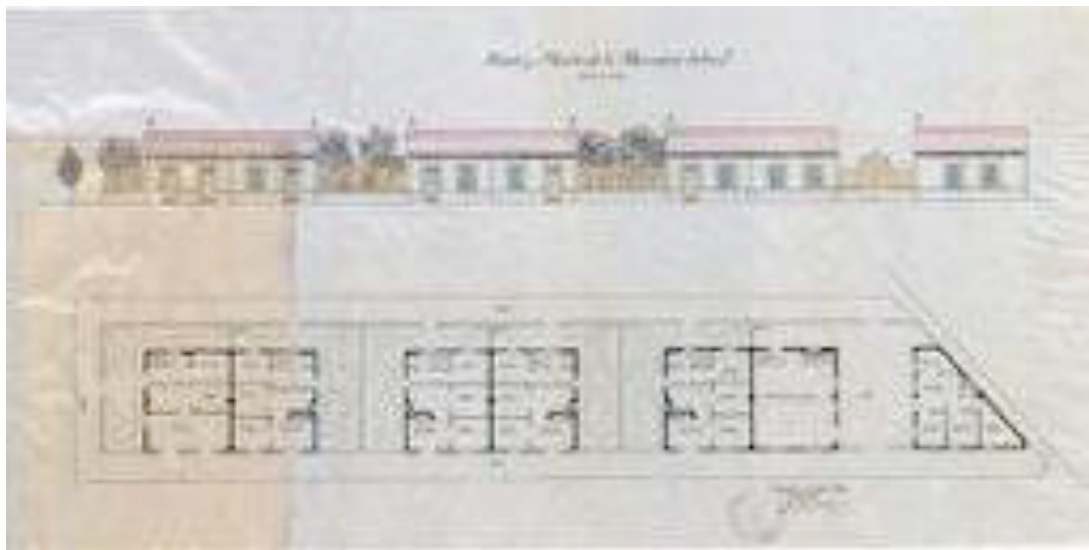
"Alzado y planta de la Manzana letra I". Francisco P. Oliver. 10 de julio de 1894. RB 02_II_3597.
